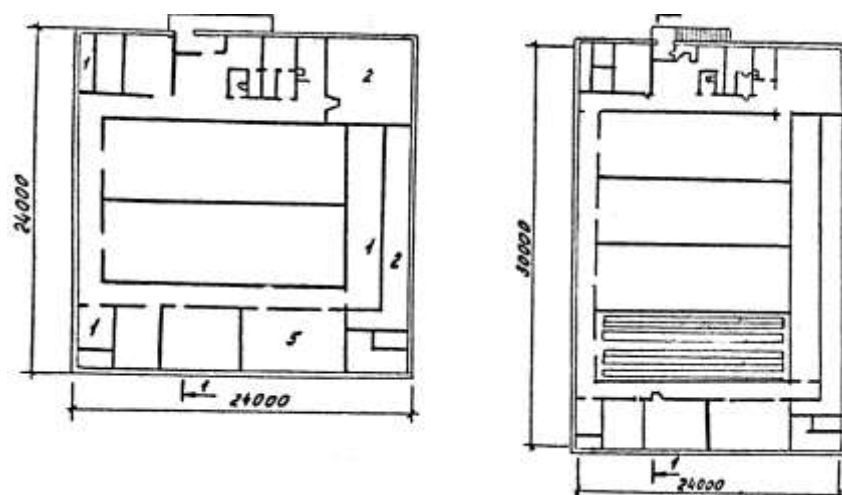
Одноэтажные светонепроницаемые теплицы с площадью камер 200 м^2 (а); 400 м^2 (б);
